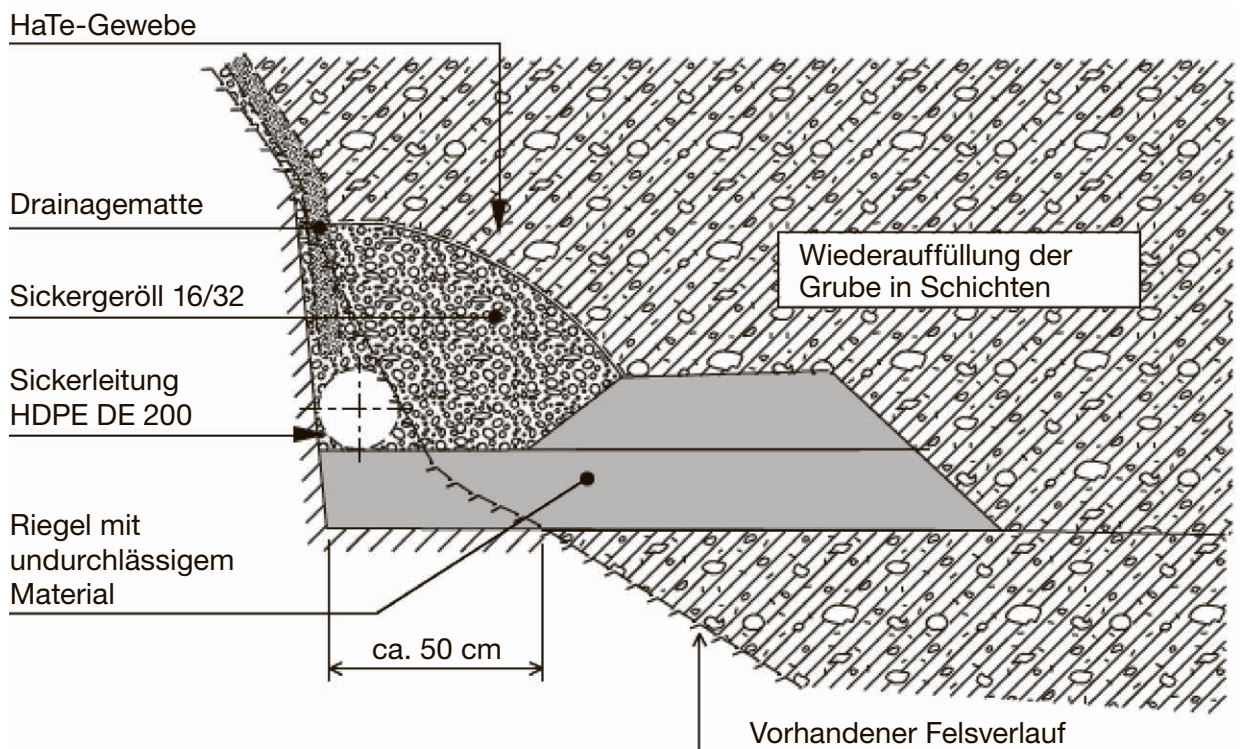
Detailskizze zur Einbindung der Hangwasserdrainage in den anstehenden Fels
